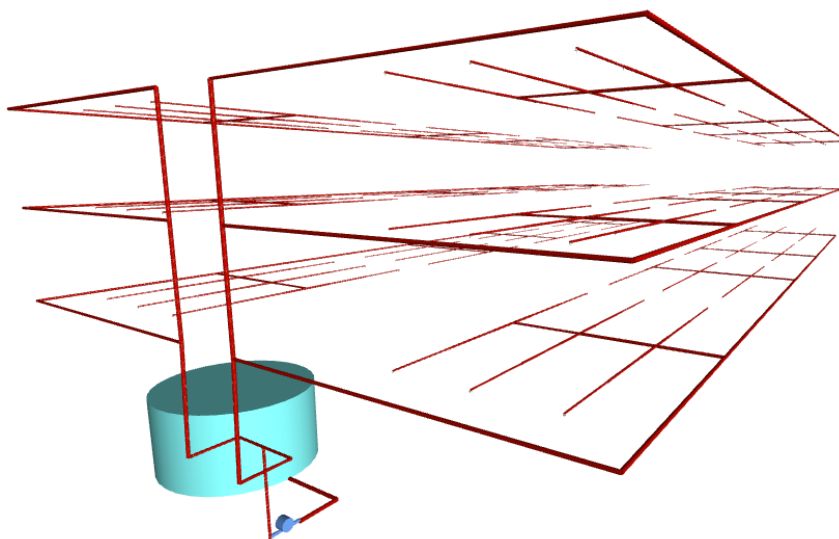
Vista 3D red de rociadores proyectada. Fuente propia (CYPE FireSprinklers).
